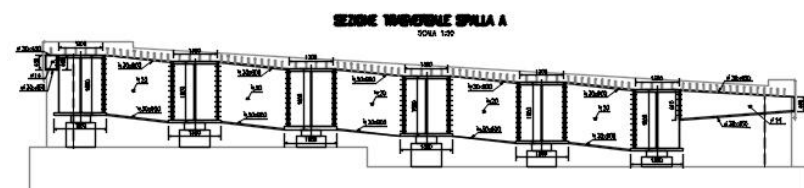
Struttura impalcato - Sezione trasversale spalla SpA
